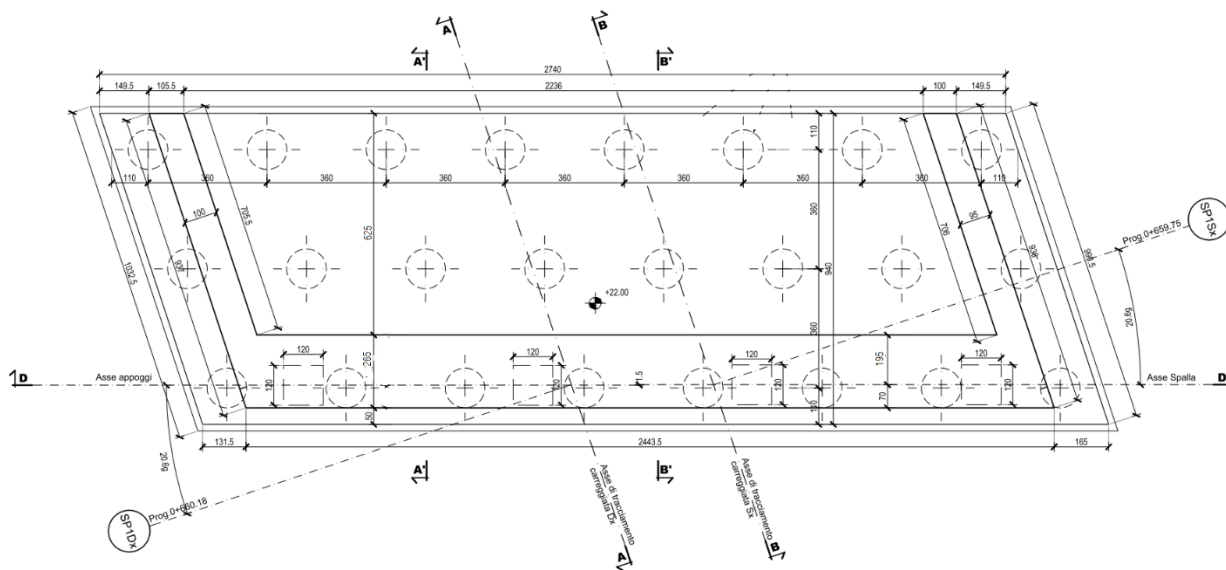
Vista planimetrica spalle SP1 ed SP2
